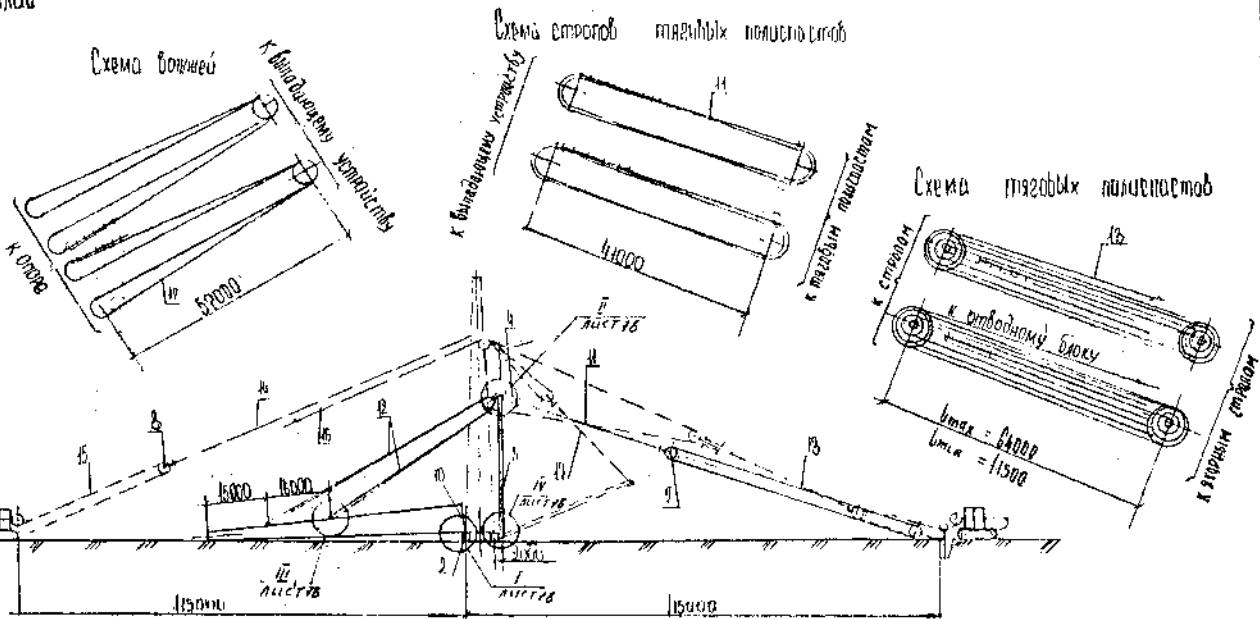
Схема подвеса опоры ГПТ 220-4/49
